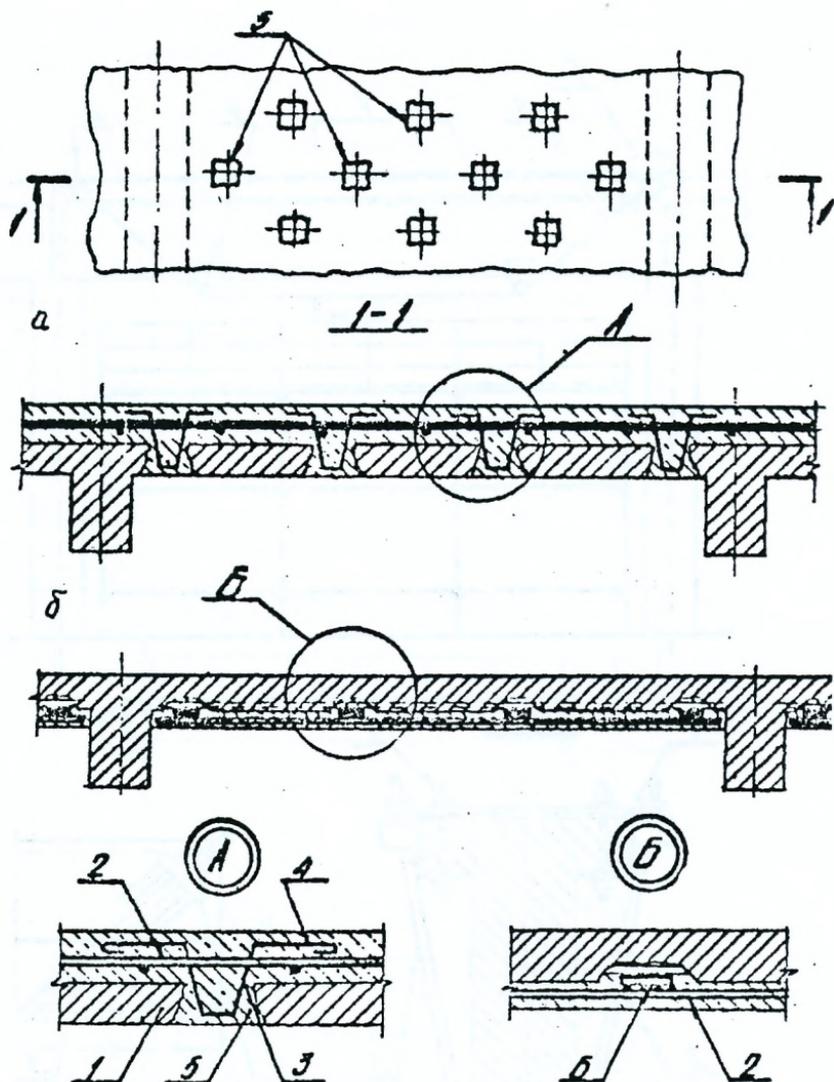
Схема усиления монолитных перекрытий наращиванием "снизу" и "сверху":
